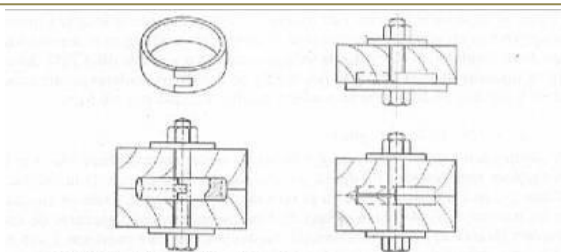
Anillos partidos (izquierda) y placas (derecha) conectoras [3].
